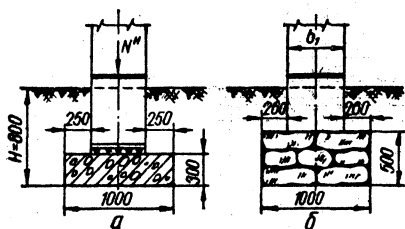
Поперечное сечение ленточного фундамента (к примеру 5):
